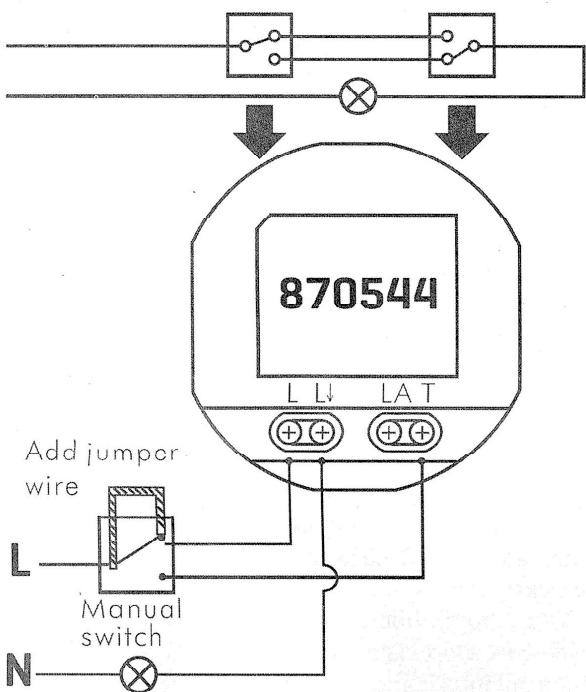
demontageschema / Fig. 3: Dismantling plan
